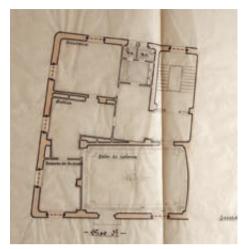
Planta principal del proyecto de ayuntamiento de Cosuenda, 1921 (A.D.P.Z.).
